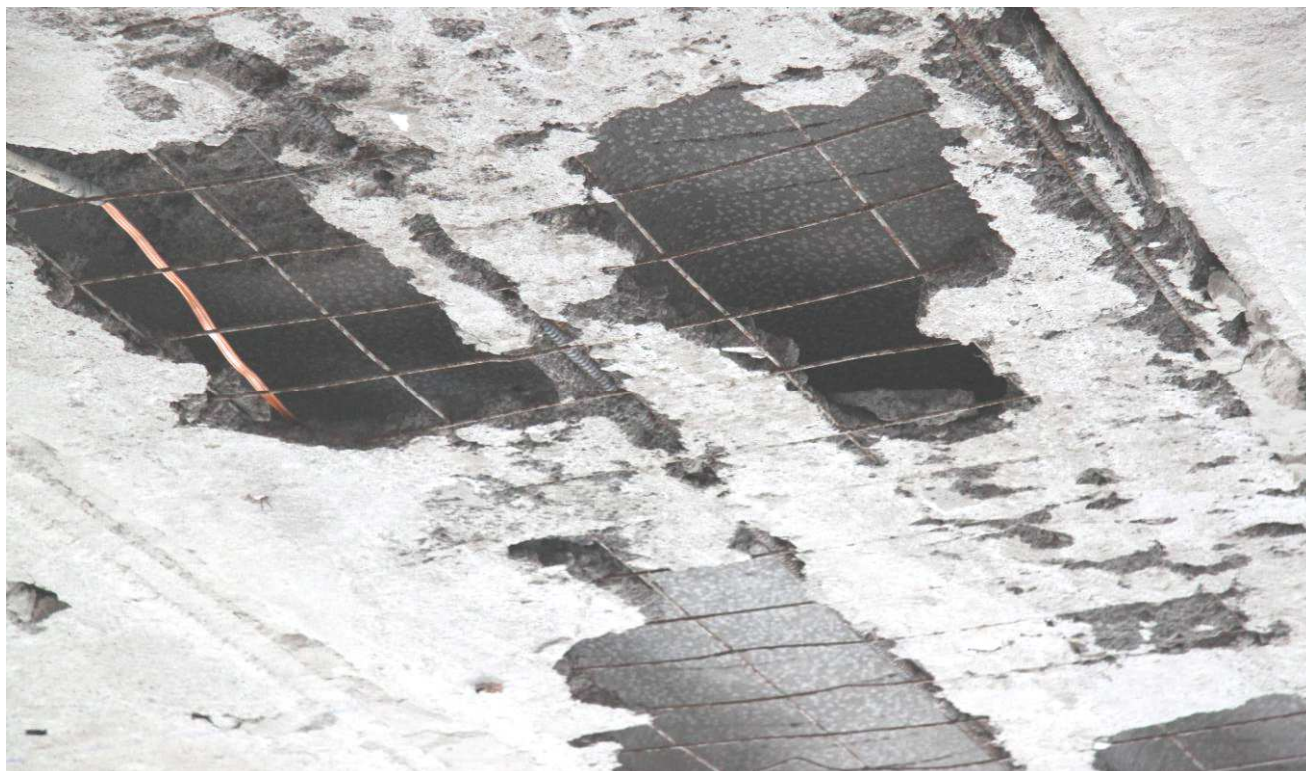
Дефект плиты перекрытия 2 этажа м.о. 4-7
